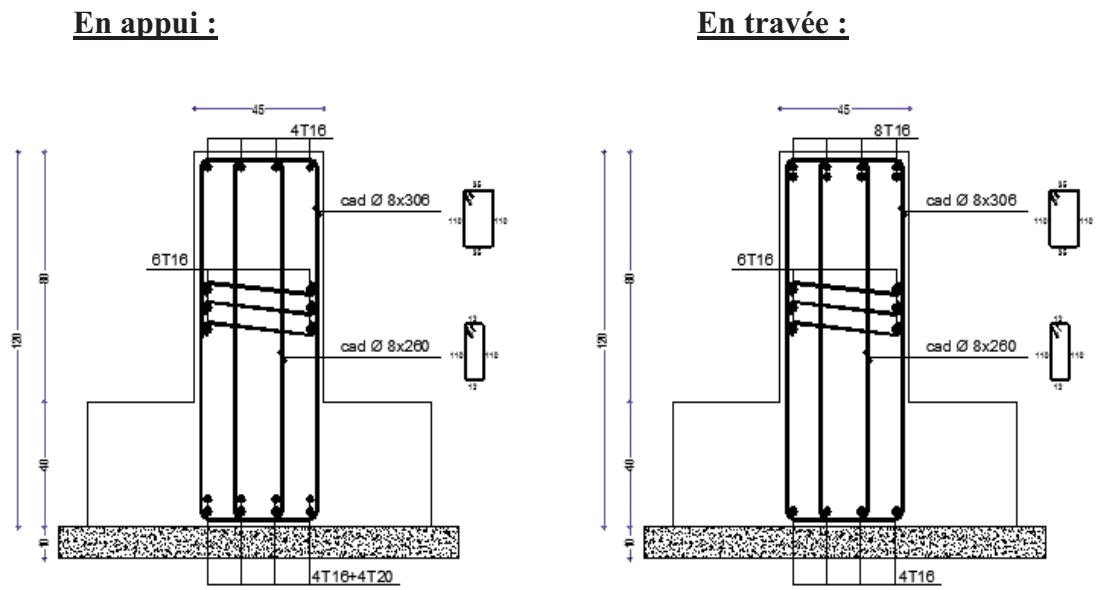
Dessin de ferrailage d'une poutre principale
